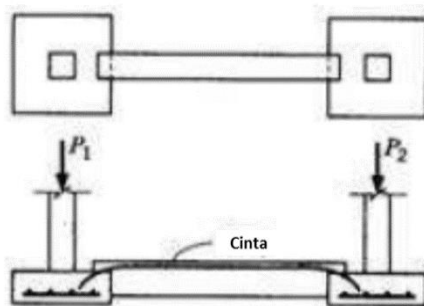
Sapatas ligadas por viga de fundação (Brito (2011)).
